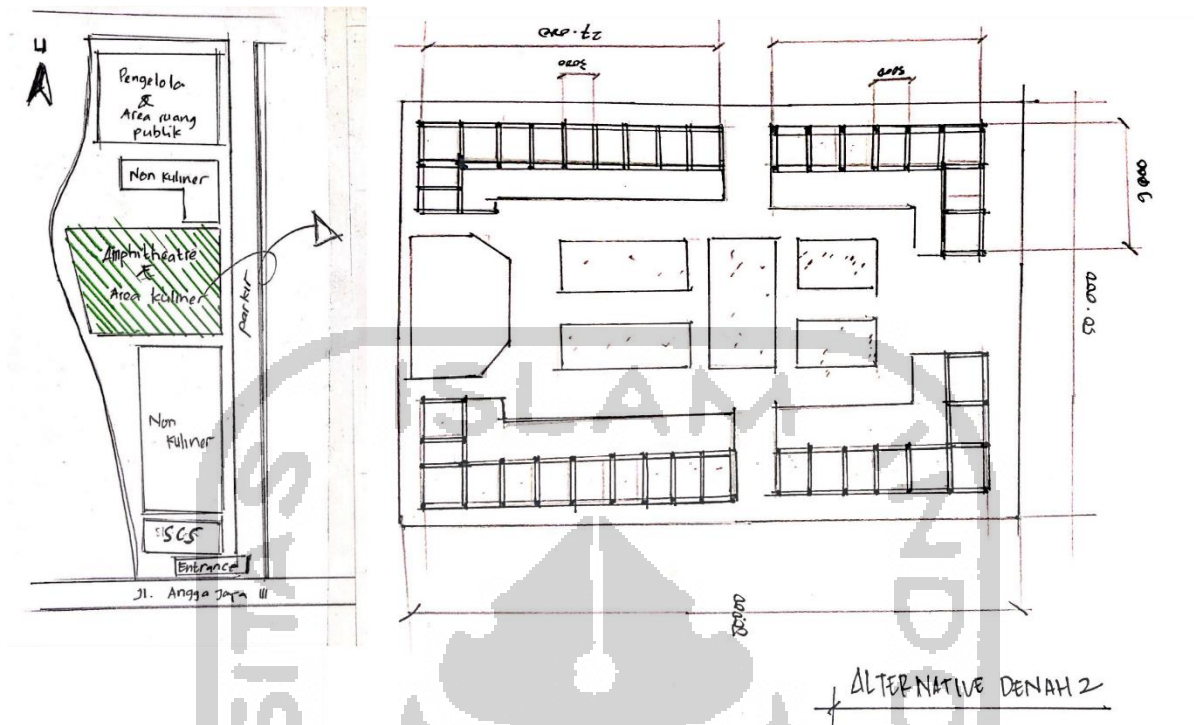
12 Zonasi Alternatif denah Mikro Site Perancangan
